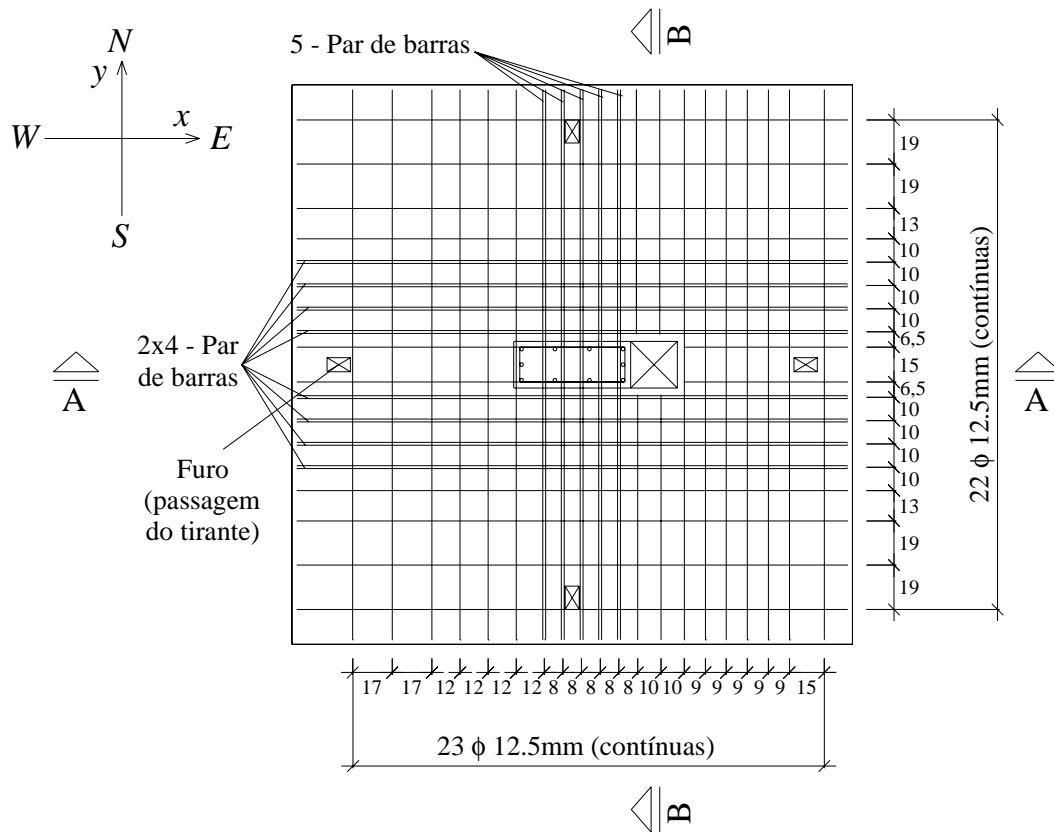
Armadura de flexão da laje L6 (cm)
